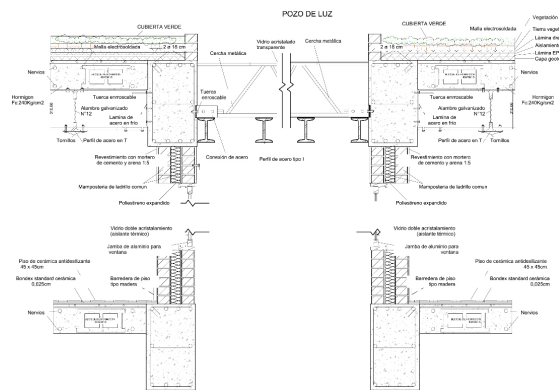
Detalle constructivo del ducto de iluminación y material térmico. Fuente: Elaboración propia.
